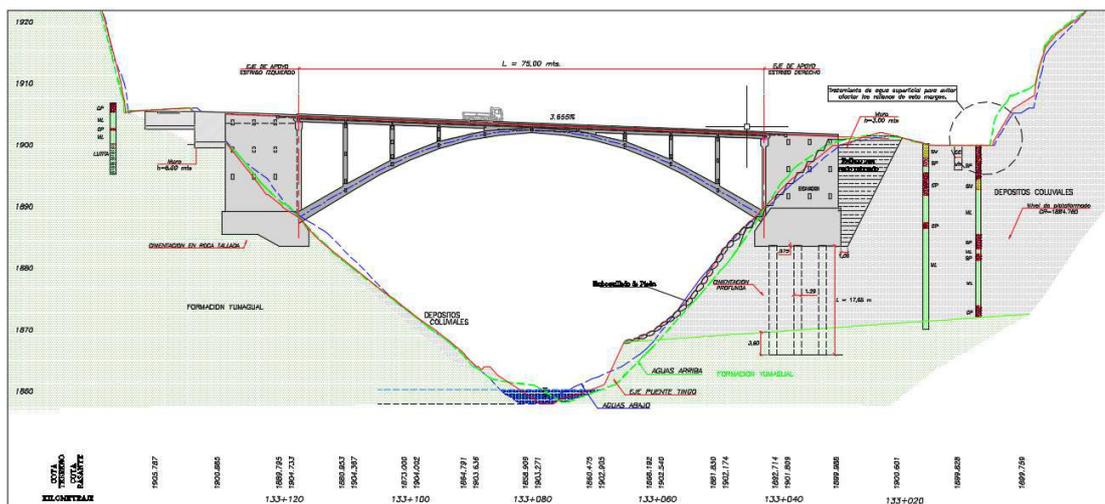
Vista en elevación del Puente el Tingo y accesos
